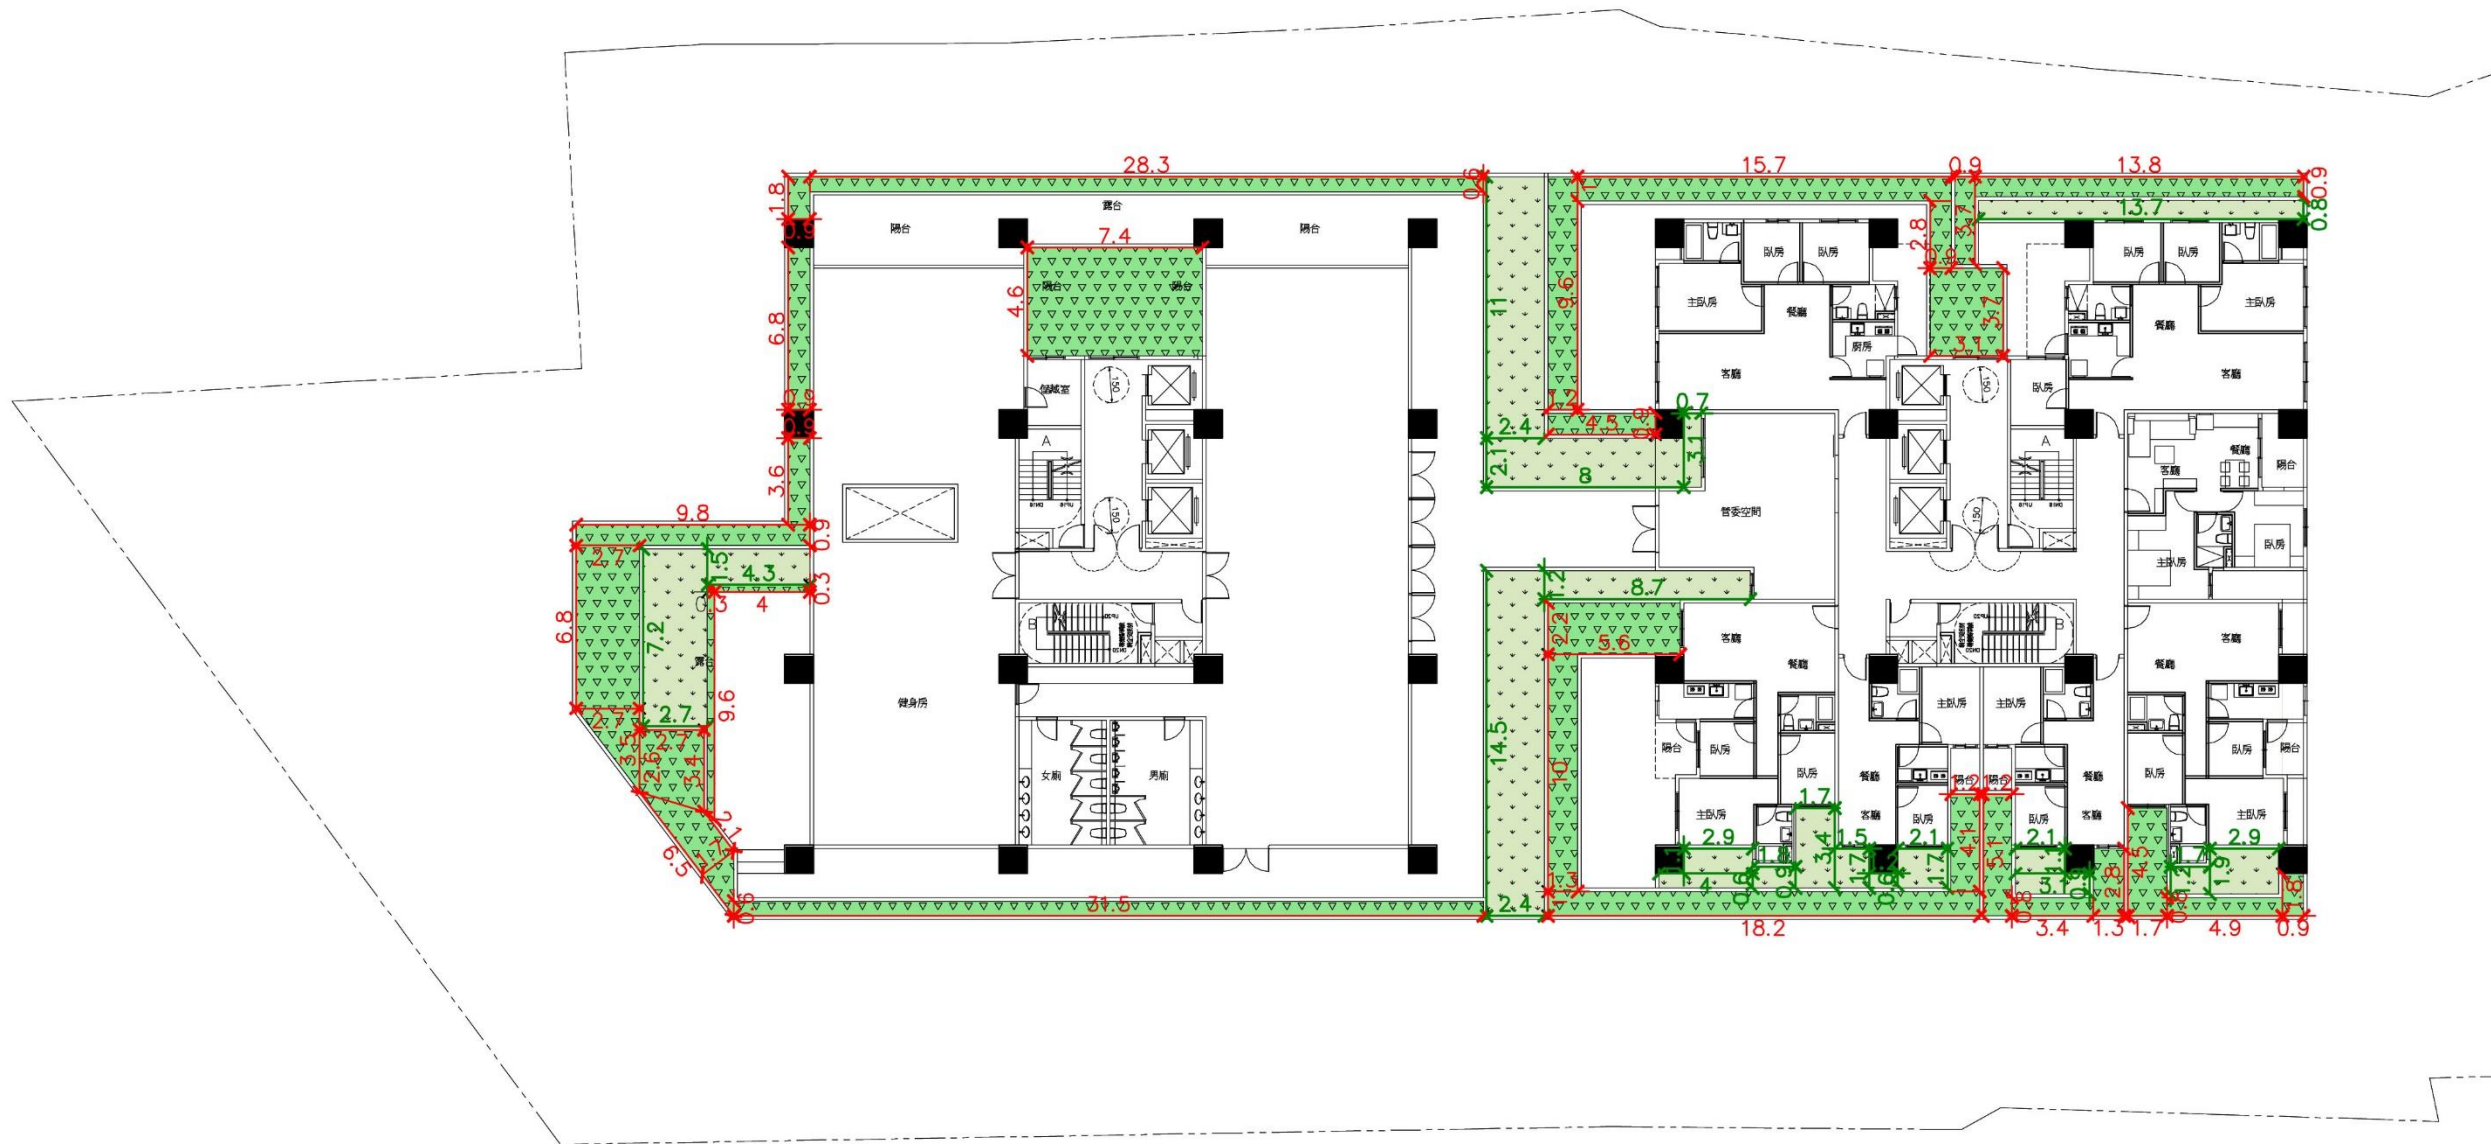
5F 露臺灌木地被計算圖說 S:1/300
